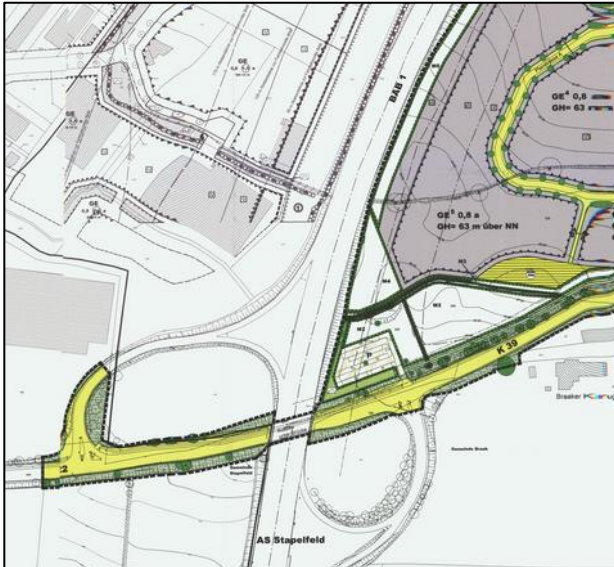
Ausschnitt Bebauungsplan Nr. 10B Gemeinde Braak, Quelle: geoportal Kreis Stormarn
